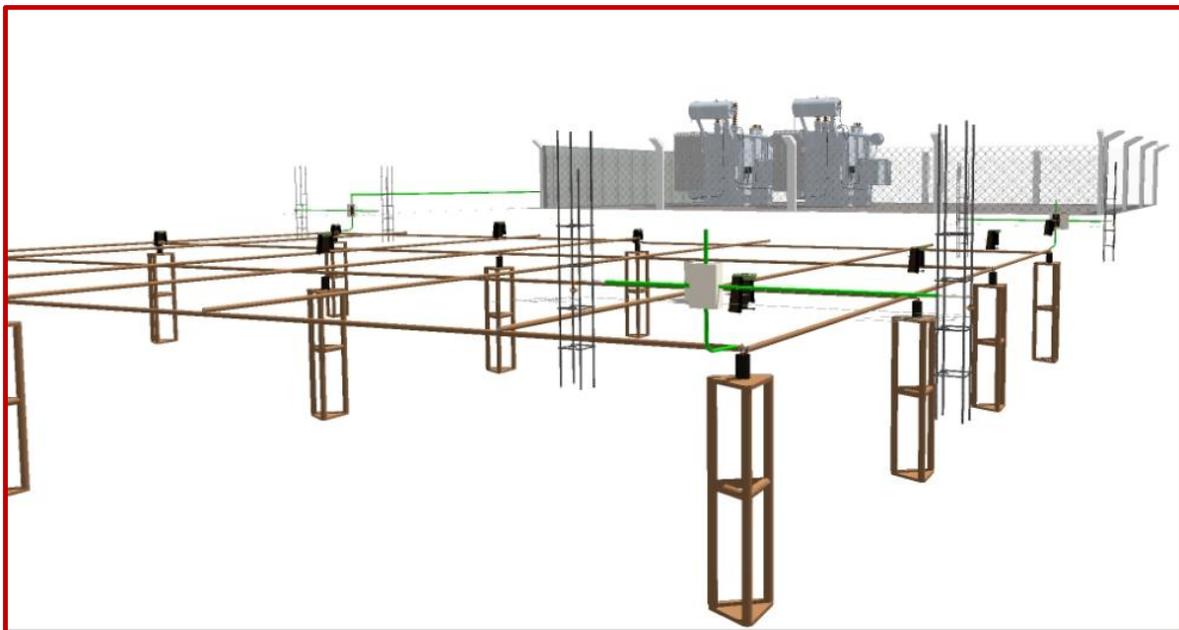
Detalles de proyecto de malla de tierra física (vista 2).
